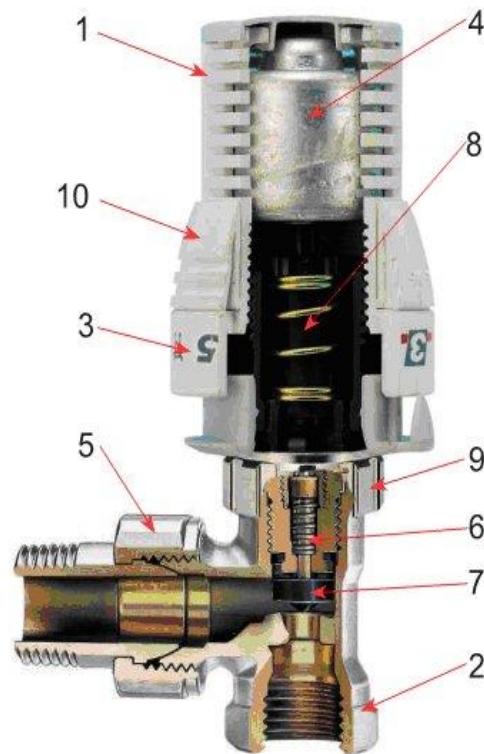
Схема терморегулятора: 1 - термостатичний елемент; 2 - термостатичний клапан; 3 - шкала налаштування; 4 - чутливий елемент (робоча середовище-рідина); 5 - роз'ємне з'єднання; 6 - шток; 7 - золотник; 8 - компенсаційний механізм; 9 - накидна гайка; 10 – кільце, яке фіксує задану температуру
